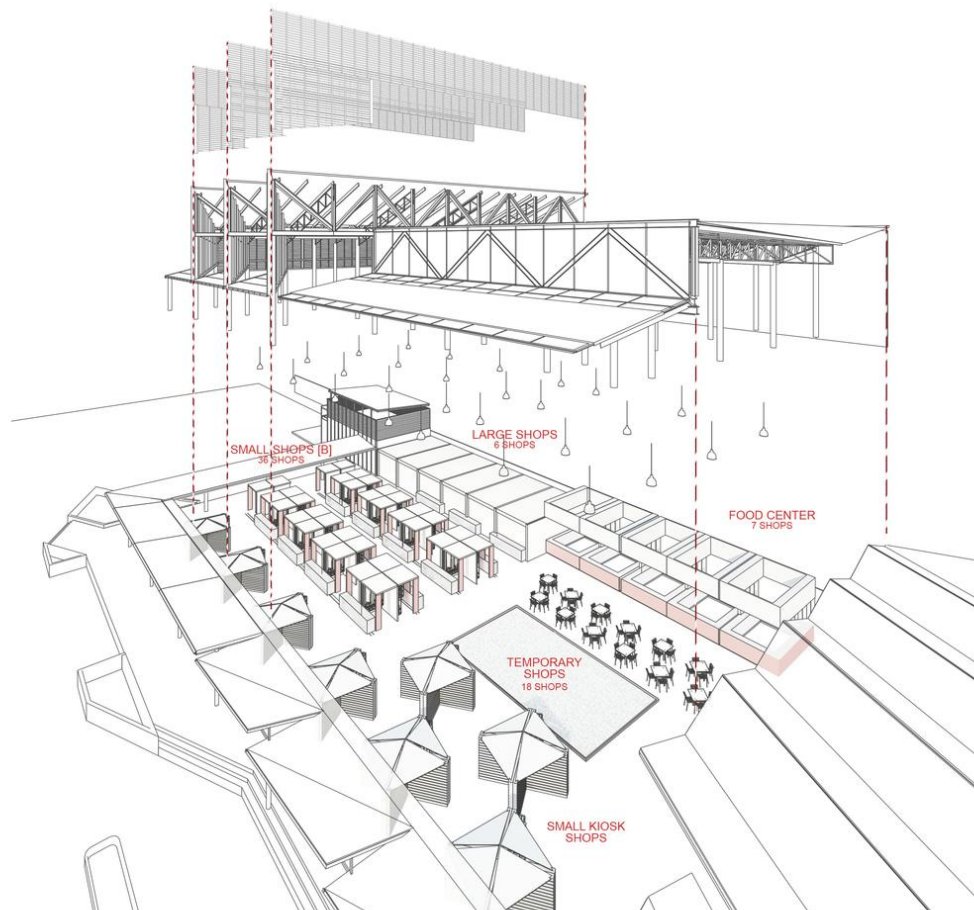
Planta explodida, Mercado da Vila. Fonte: Archdaily
